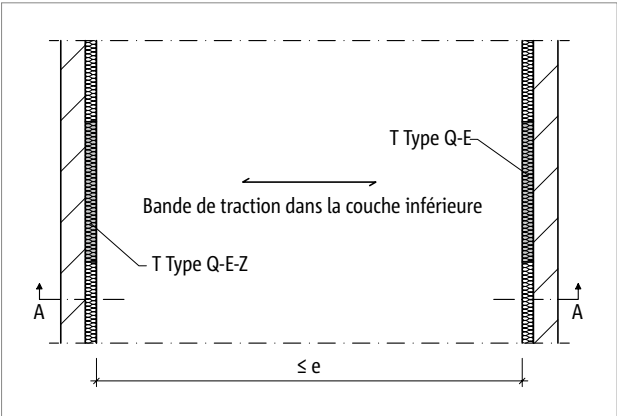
Schöck Isokorb® T Type Q-E, Q-E-Z : Application d'une dalle de béton armé à axe unique
